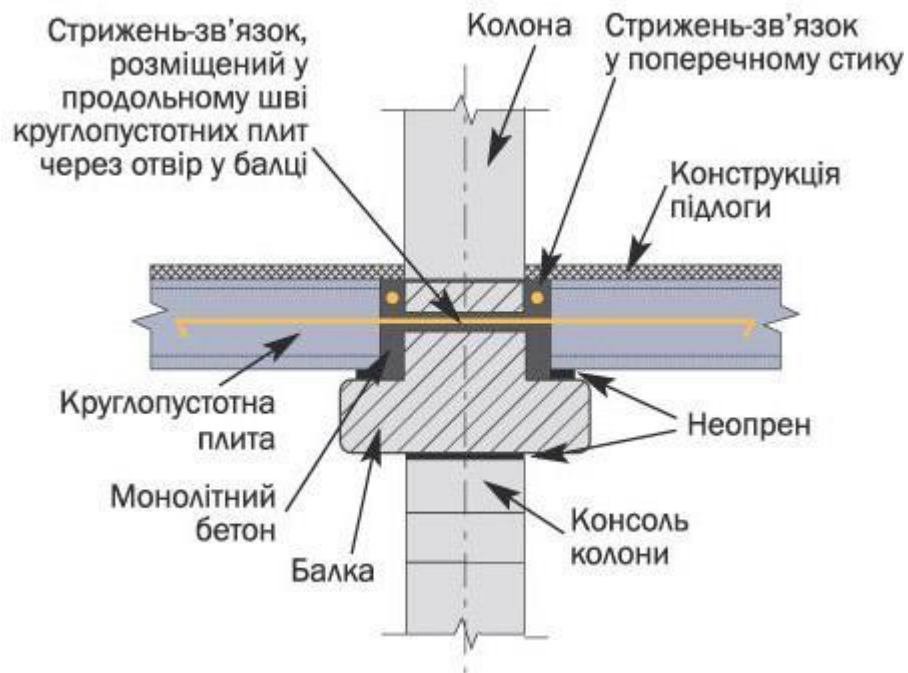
Вузол примикання круглопустотних плит перекриття до колони [38]
